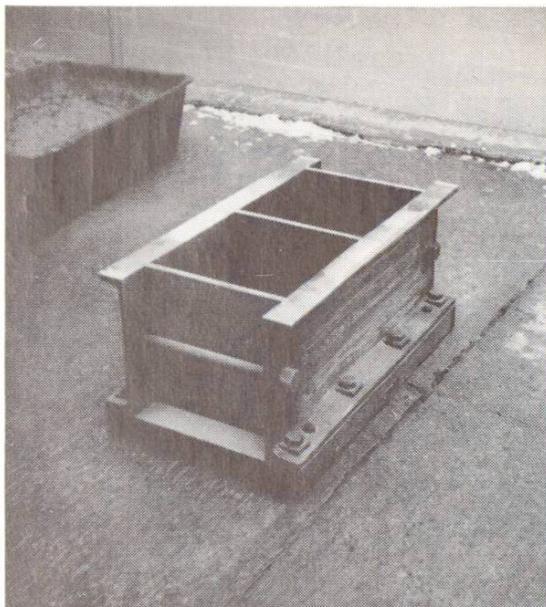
Moule en acier pour éprouvette cubique de 20 cm
